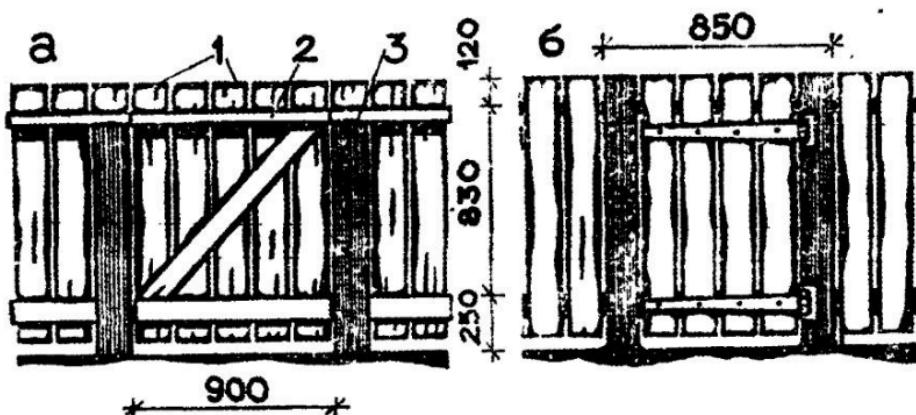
Устройство калитки: а — детали конструкции; б — вид со стороны петель;
